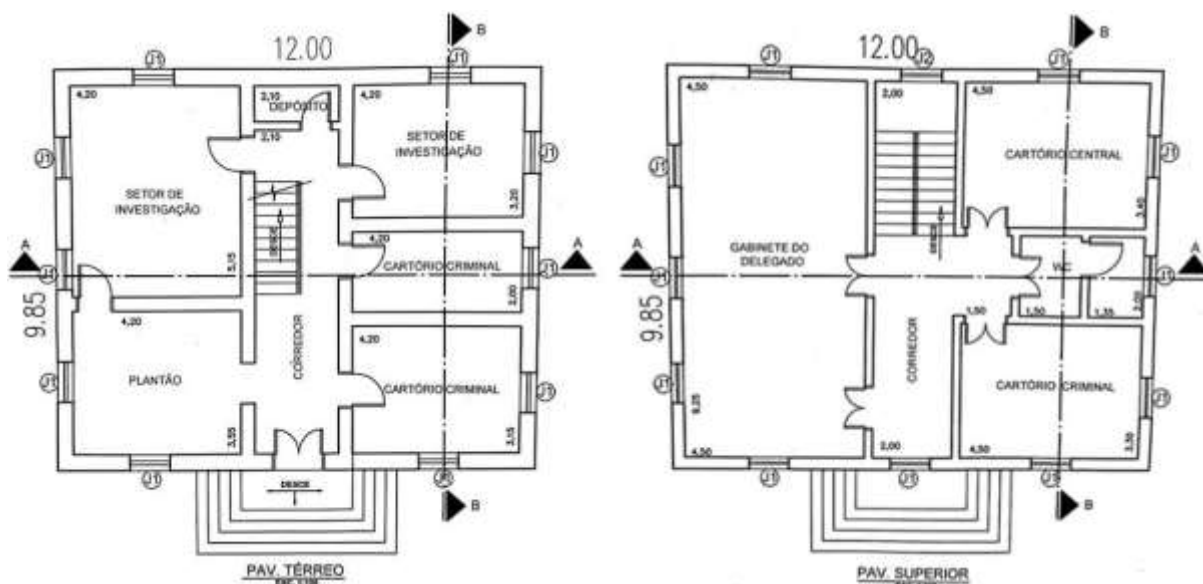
Planta Baixa Atual Térreo e Planta Baixa Atual Pavimento Superior
